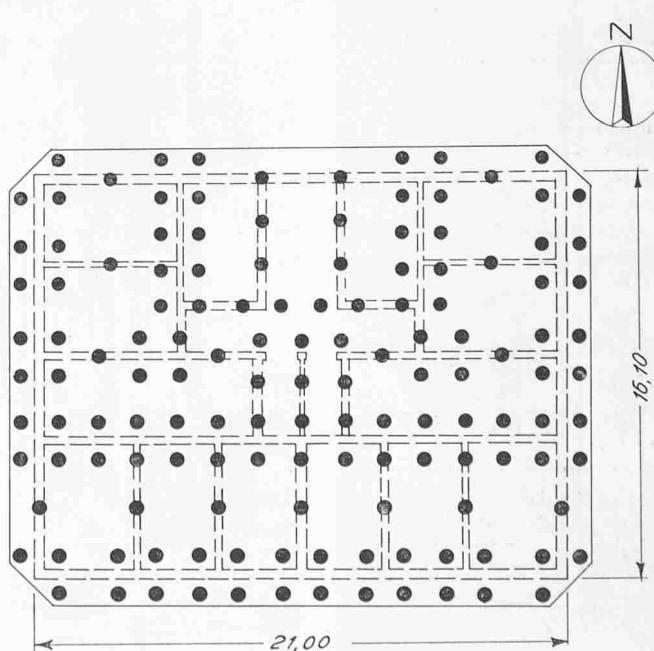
Anordnung der Pfähle im Grundriss des Hochhauses
